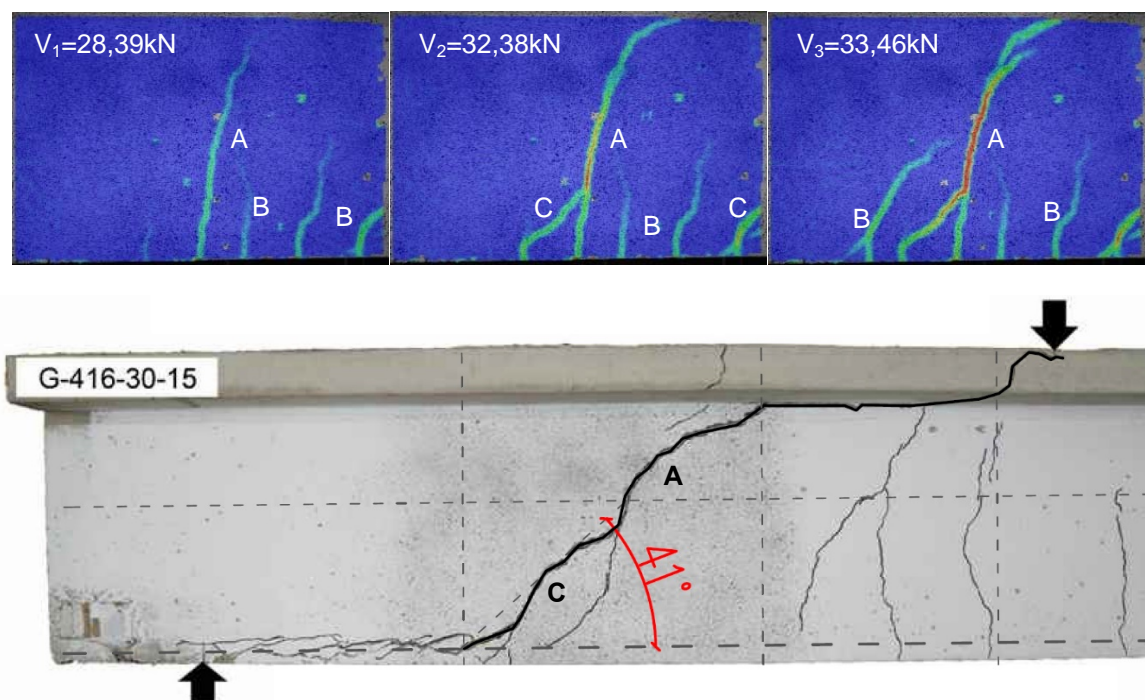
Sposób zarysowania belek ze zbrojeniem stalowym, II seria
